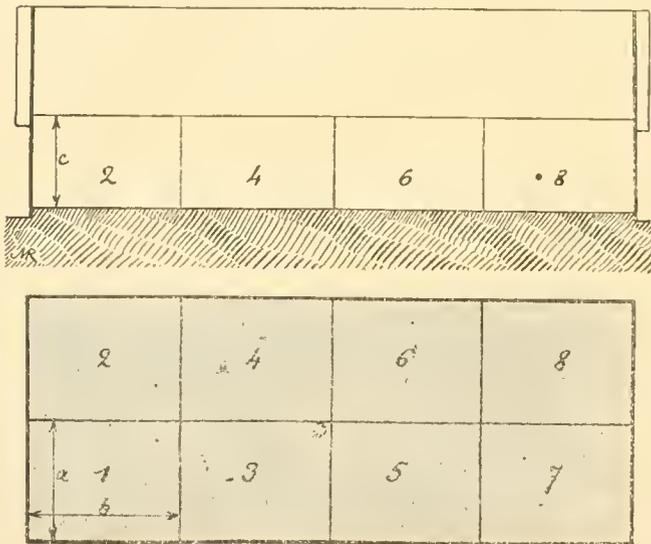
Maison en rez-de-chaussée (plan et élévation).
